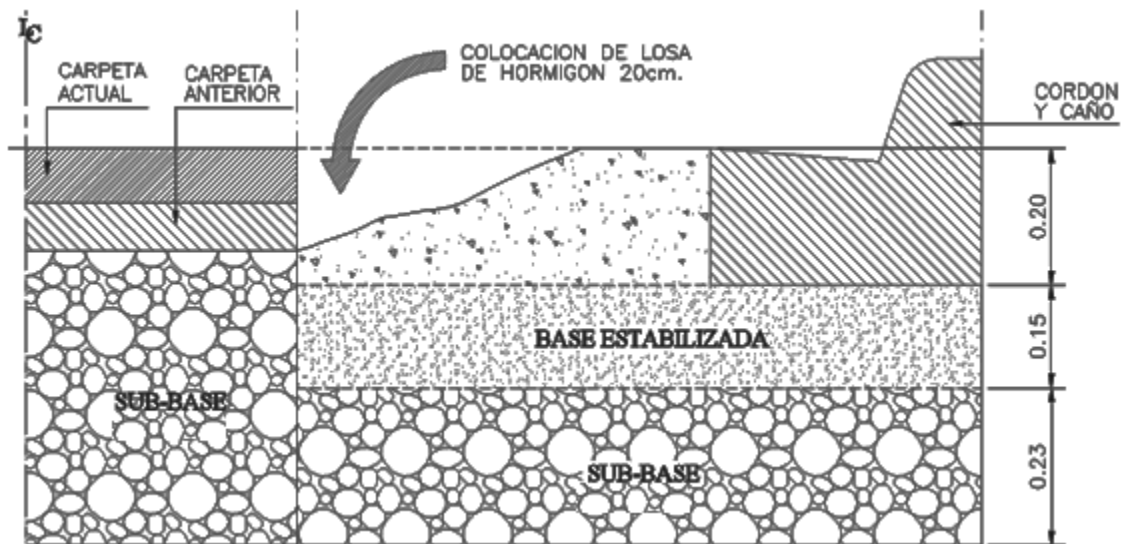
Esquema del mejoramiento que se describe en planos a realizar en la ruta 204. (Fuente: Planos constructivos suministrados por la empresa constructora)
